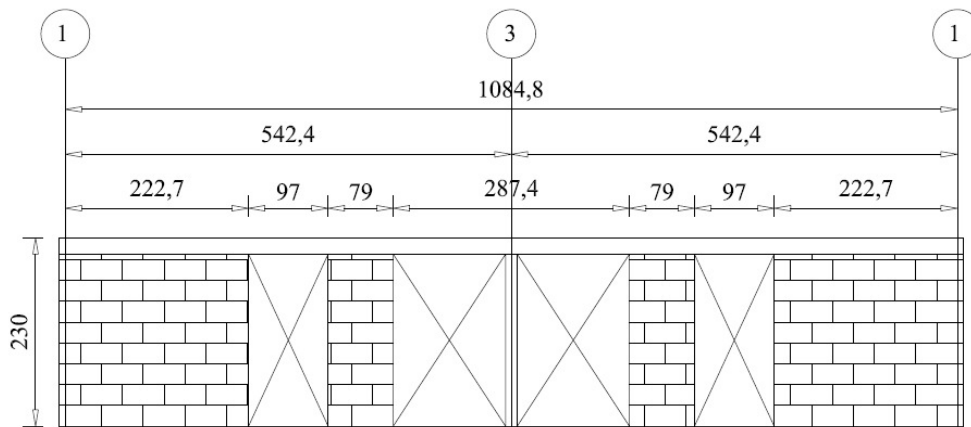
Dimensiones de la planta de la Vivienda para Ancianos (Caso 241).
